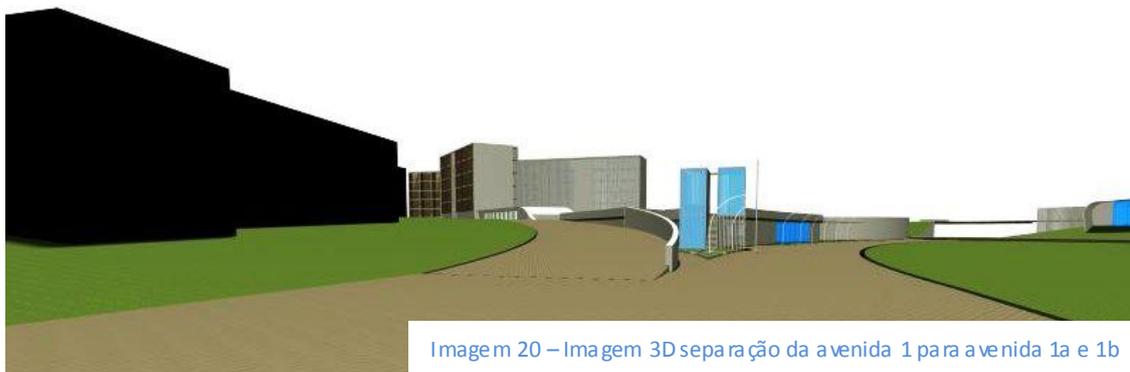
Imagem 3D separação da avenida 1 para a avenida 1a e 1b
